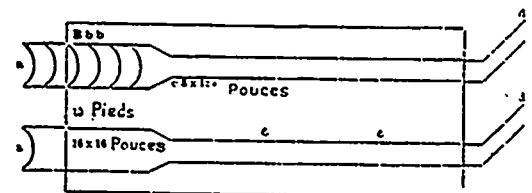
Couche-chaude américaine chauffée au feu. Plan des conduits souterrains.
